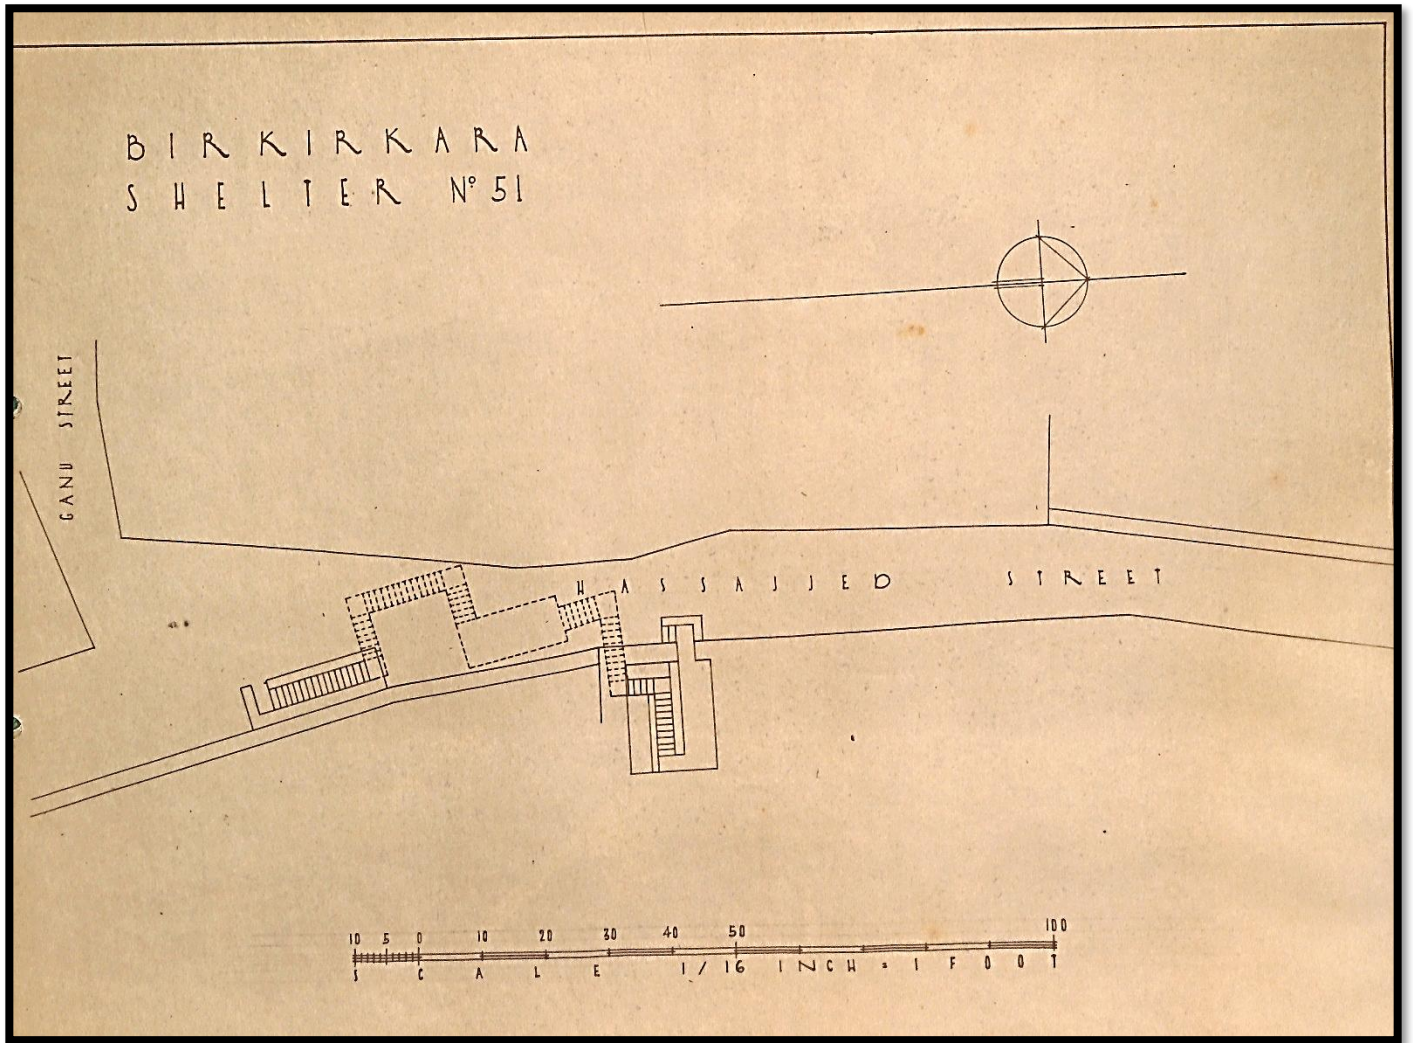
Planta do Abrigo nº51 "Hassajjeo Street."
